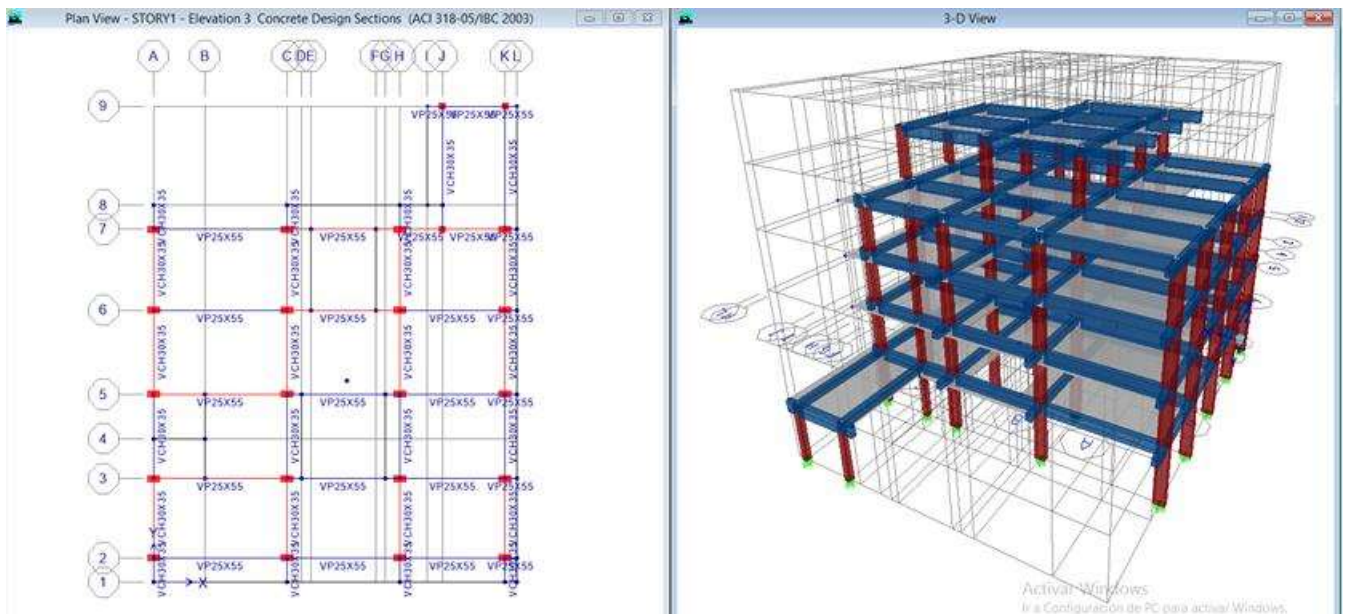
vista de planta y 3d del edificio diseñado de concreto armado con su predimensionamiento
